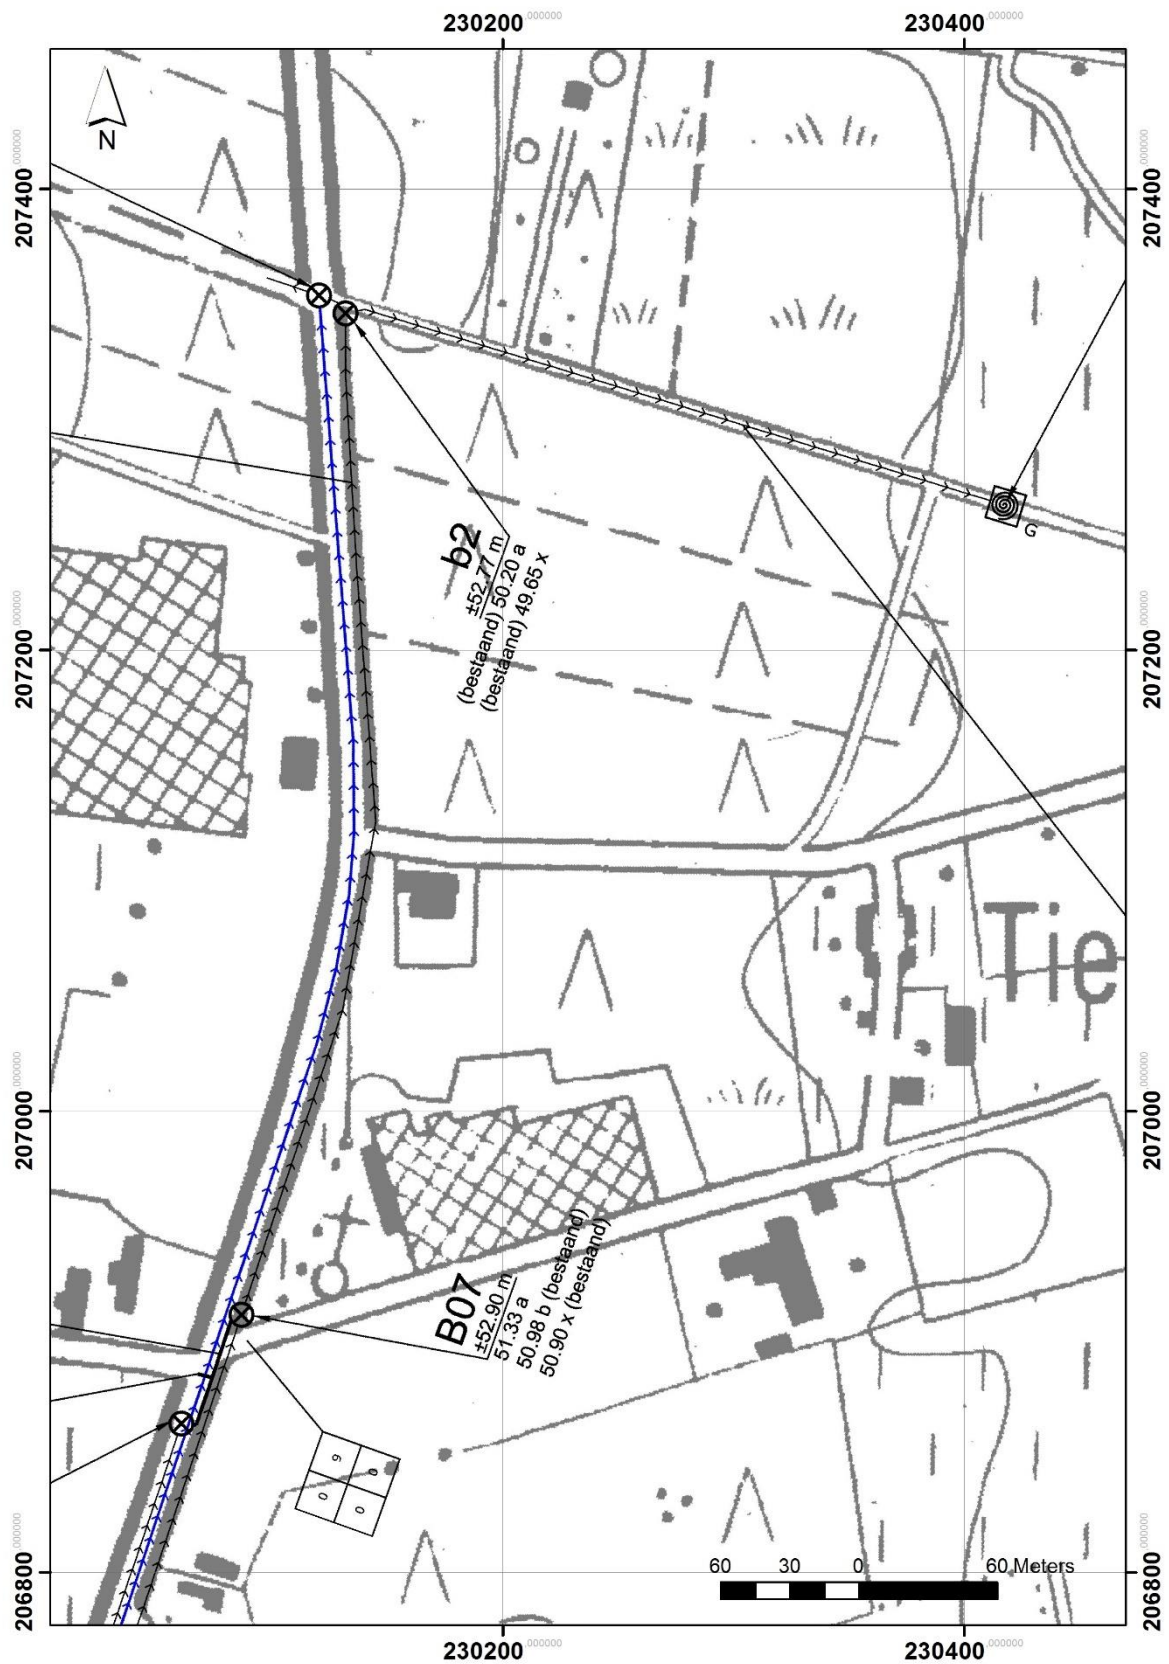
ontwerpplan met schematische aanduiding van de opdeling (volledig plan wordt ook als digitale bijlage toegevoegd)
